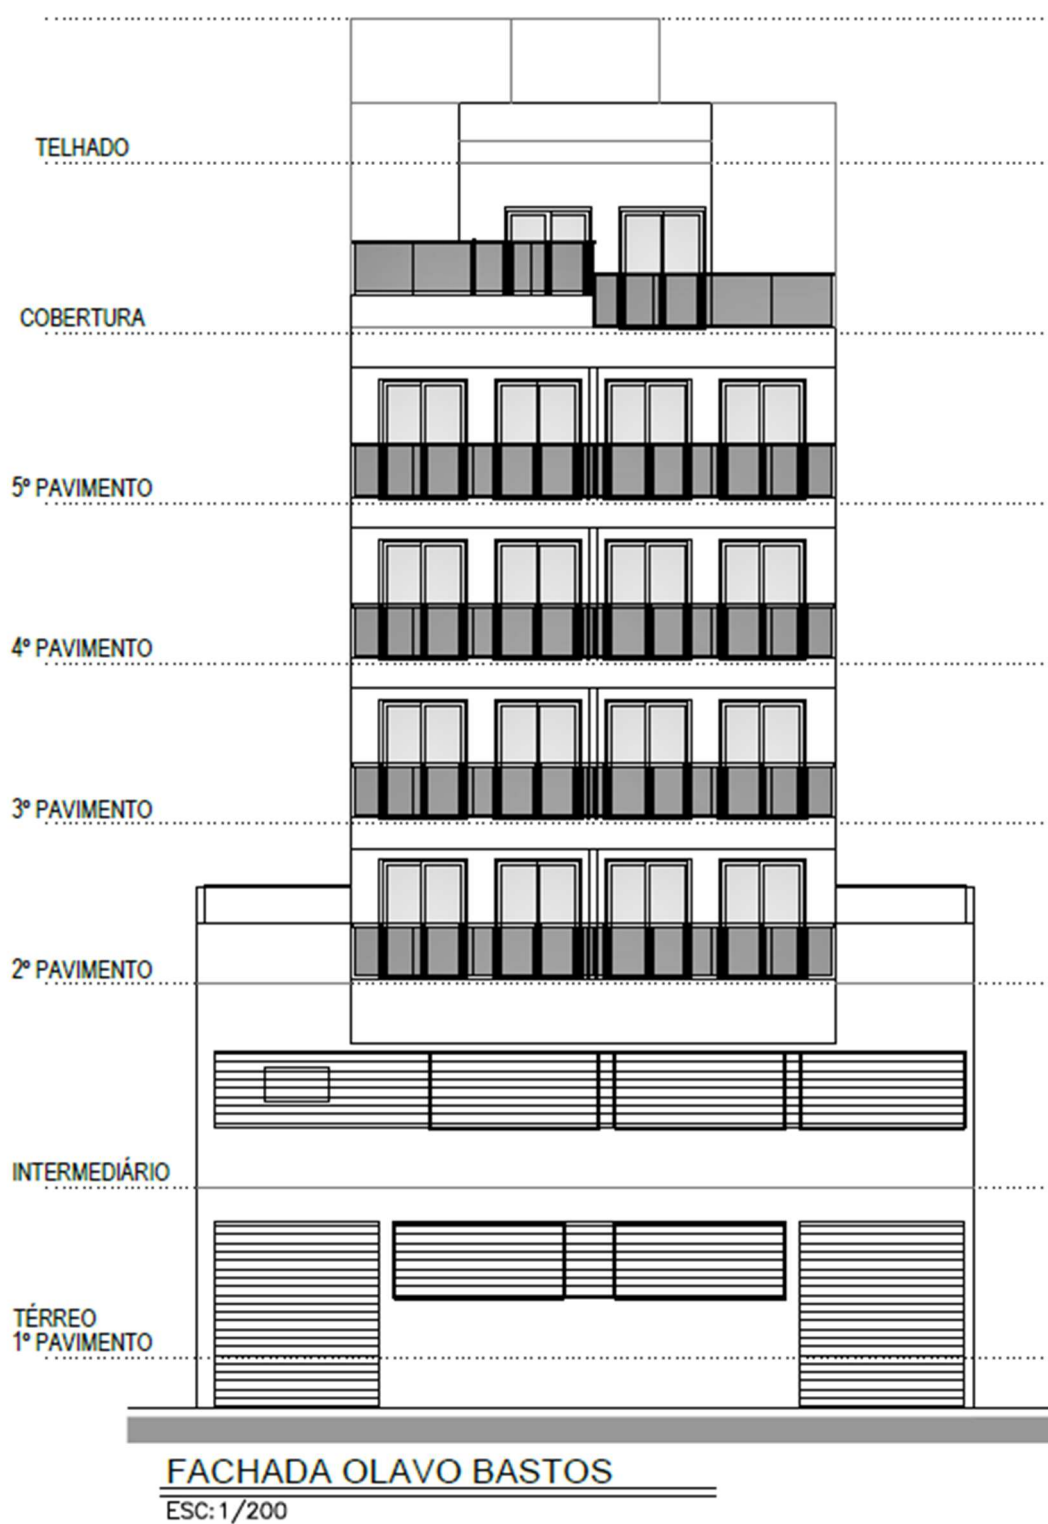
Fachada Olavo Bastos - Fonte: Projeto Legal
